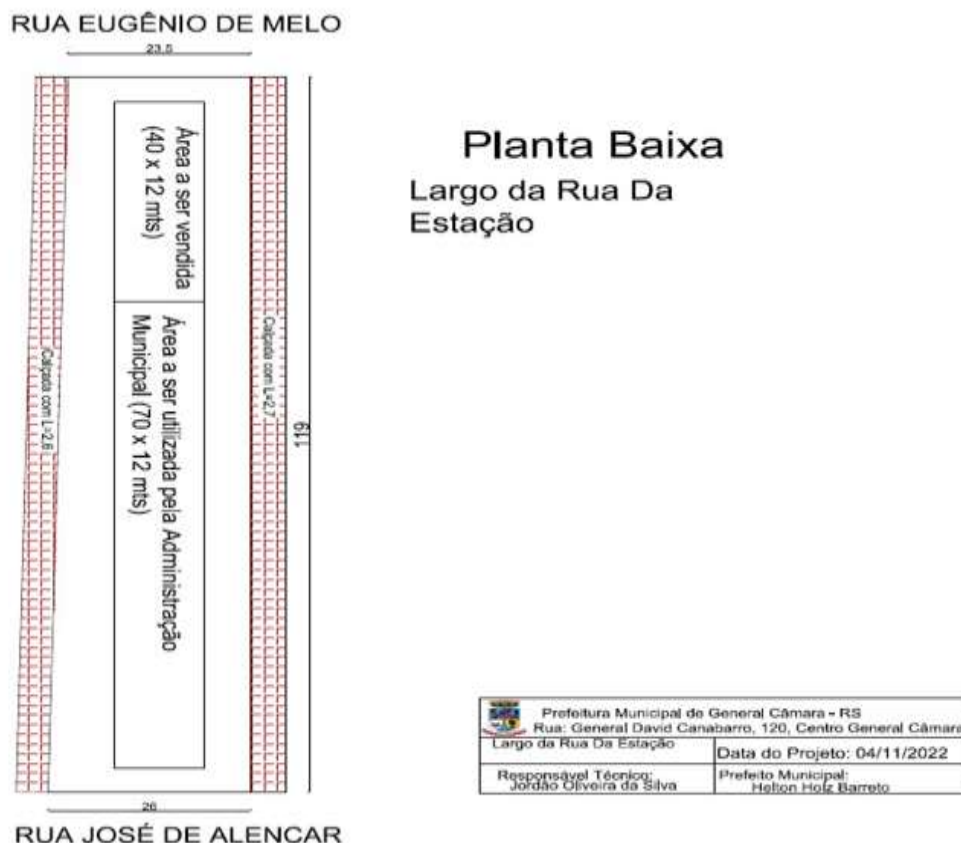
/02 – Planta Baixa _ Destaque para as Medidas do Trecho em Estudo.
